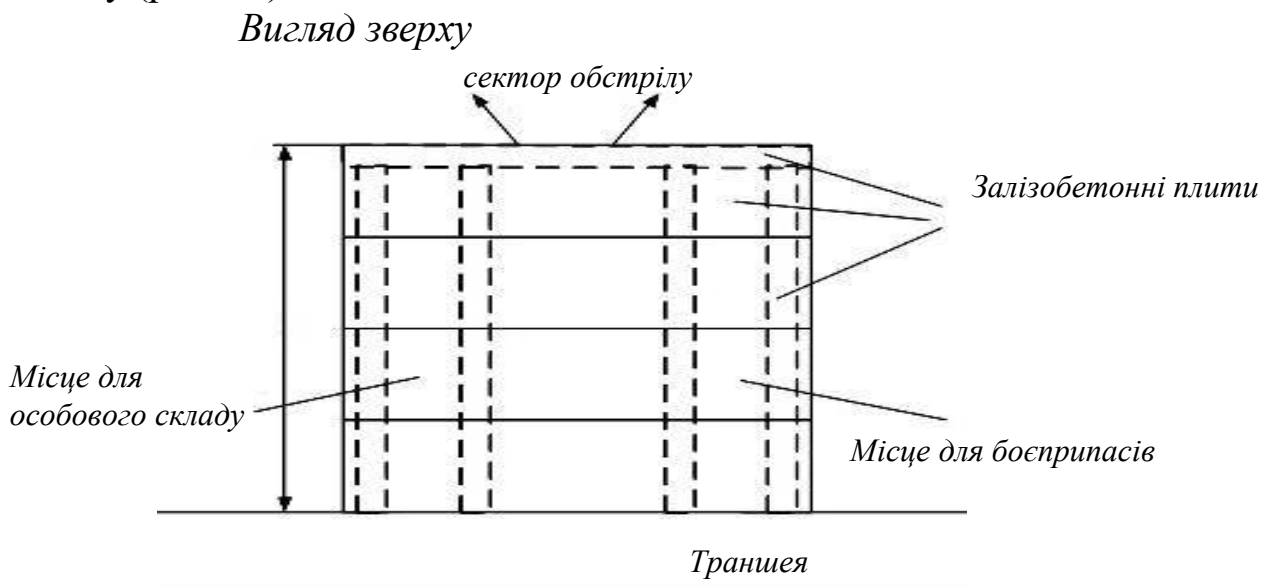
Довготривала споруда для ведення вогню з залізобетонних плит
